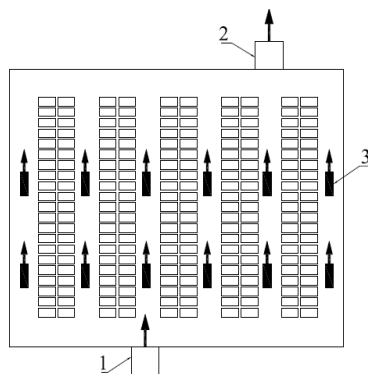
Схема работы системы струйной вентиляции в штатном режиме. 1 – система приточной вентиляции; 2 – система вытяжной вентиляции; 3 – струйный вентилятор
